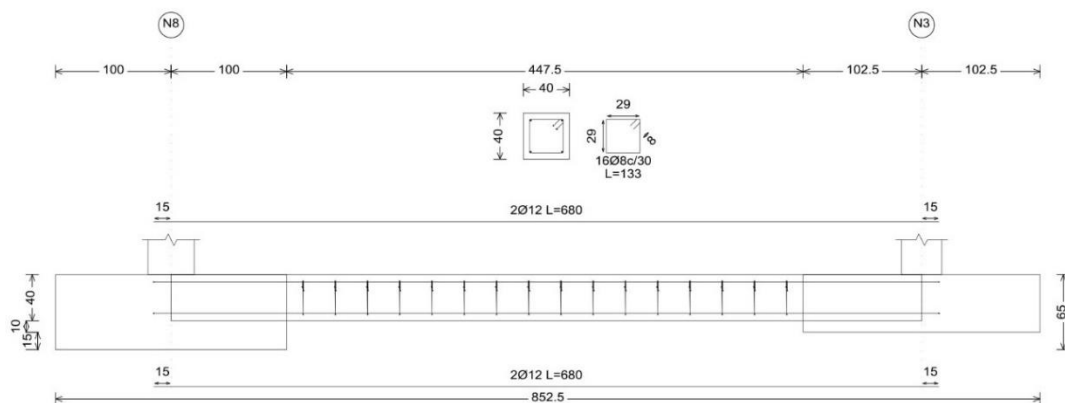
Viga de atado de los pilares de pórticos interiores. Fuente: Elaboración propia a partir de CYPE 3D
